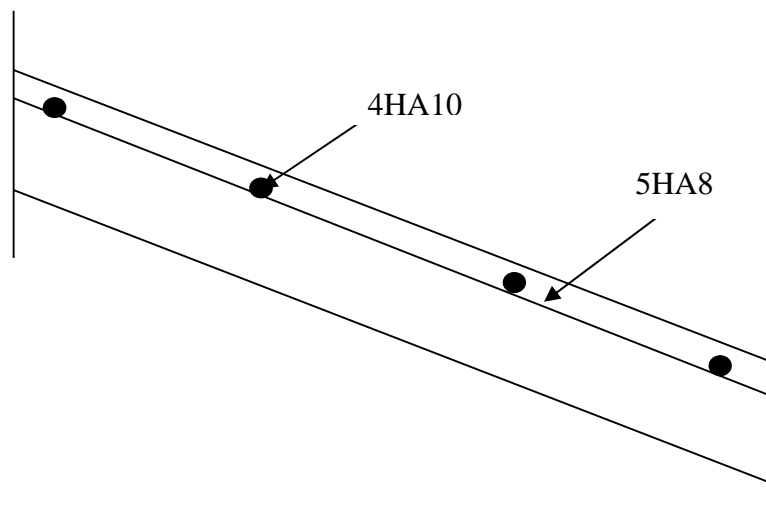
schéma de ferrailage de la volée d'escalier (type 1)
